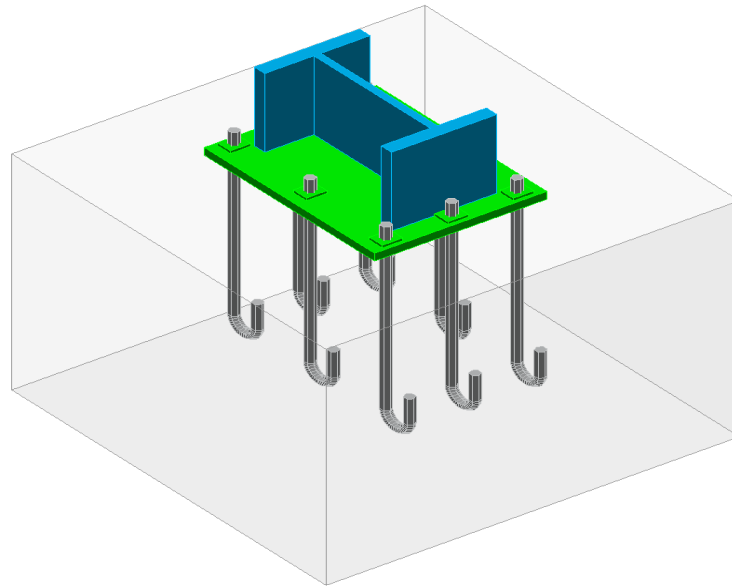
Vue 3D de la jonction poteau-fondation
